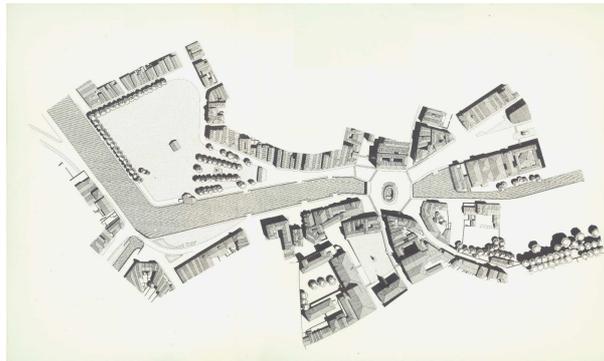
Estudo prévio do arranjo urbanístico e arquitectónico da zona central de Aveiro (proposta) pl. 68 | Plano Director da Cidade de Aveiro, 1964
